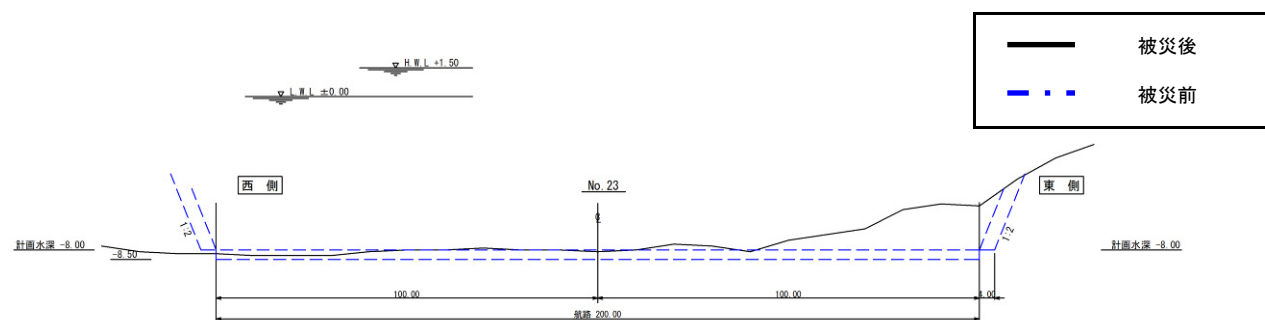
No.1 大洗港区\_中央地区航路 (-8m) の断面図 (被災後)
